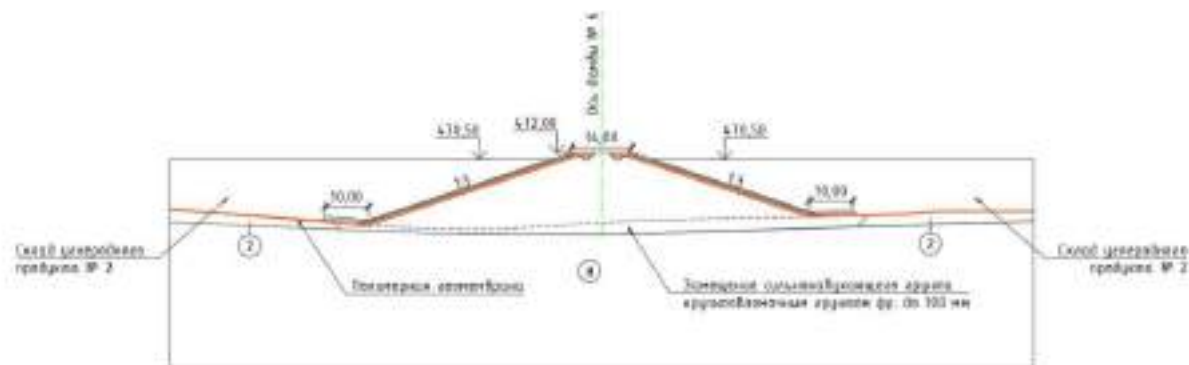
Расчетное сечение 5-5 по дамбе № 6
